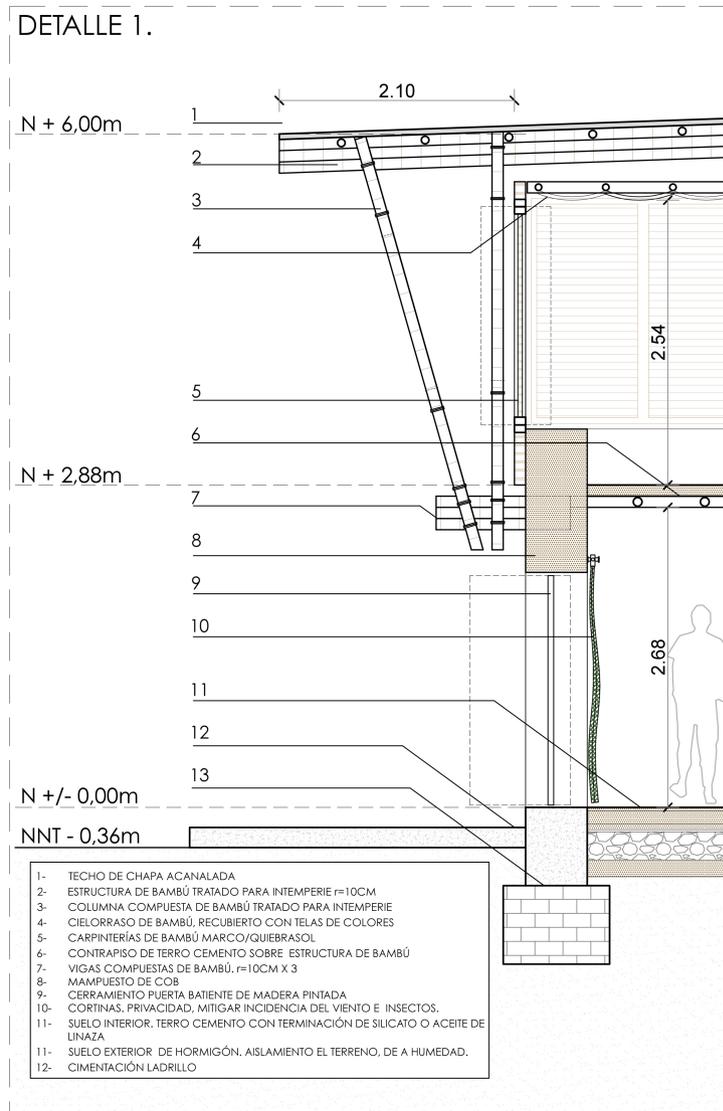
Sección transversal y Detalle constructivo donde se muestra el perfil de la fachada principal. (Fuente: Elaboración Propia tomado del portal de Anna Heringer y redibujado.)
